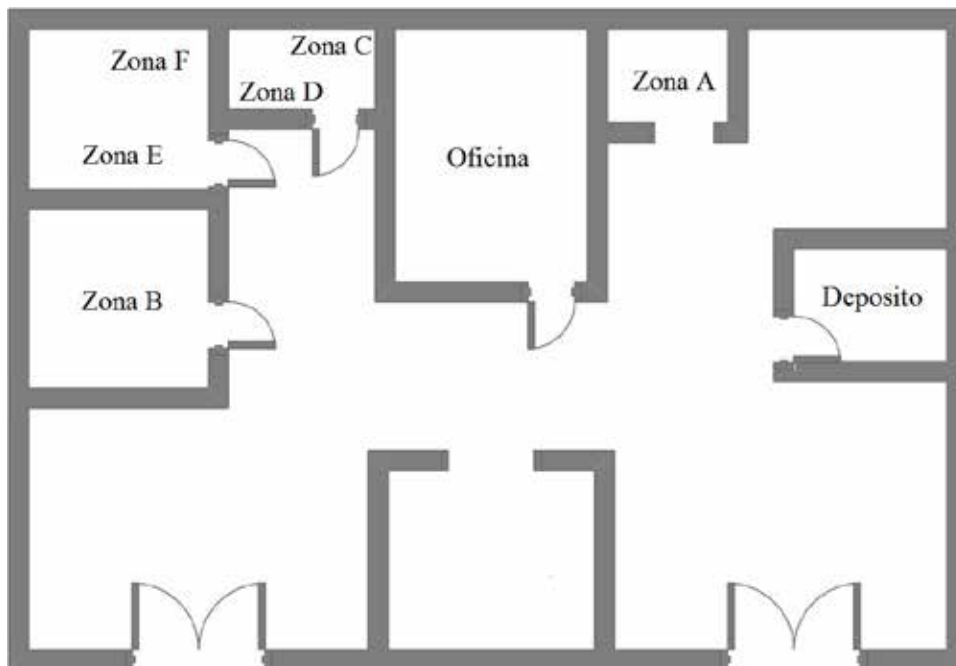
, Layout de la planta de producción de la empresa Plasquiven C.A
